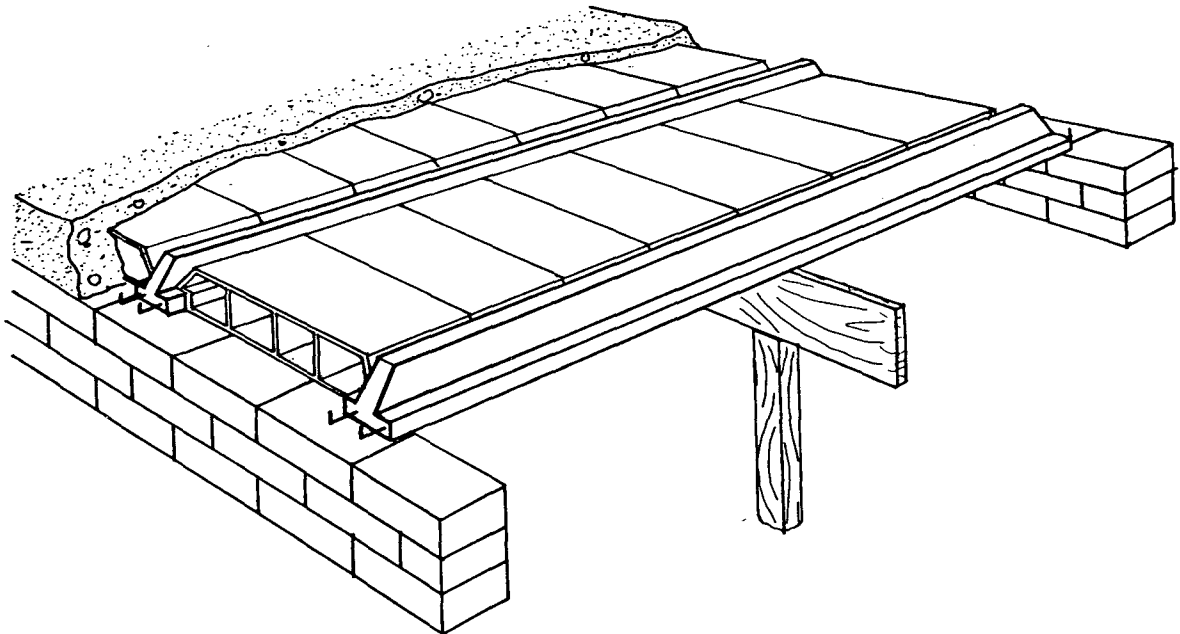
LAJE PRÉ-MOLDADA
